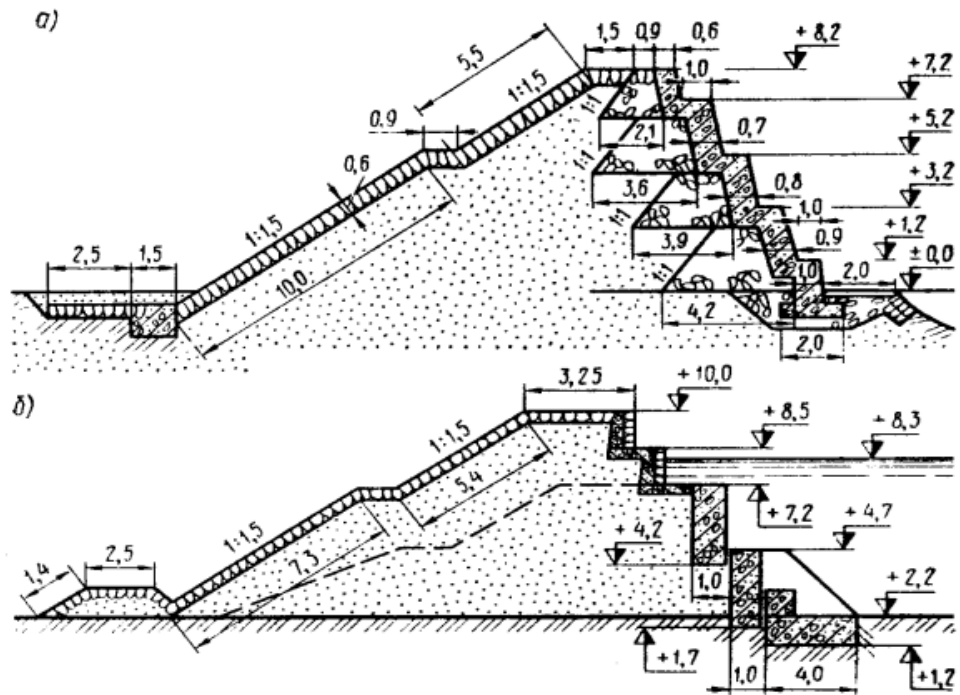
Берегозащитные морские стены с бетонной или слабоармированной железобетонной облицовкой морских граней и каменным мощением на тыловых поверхностях
